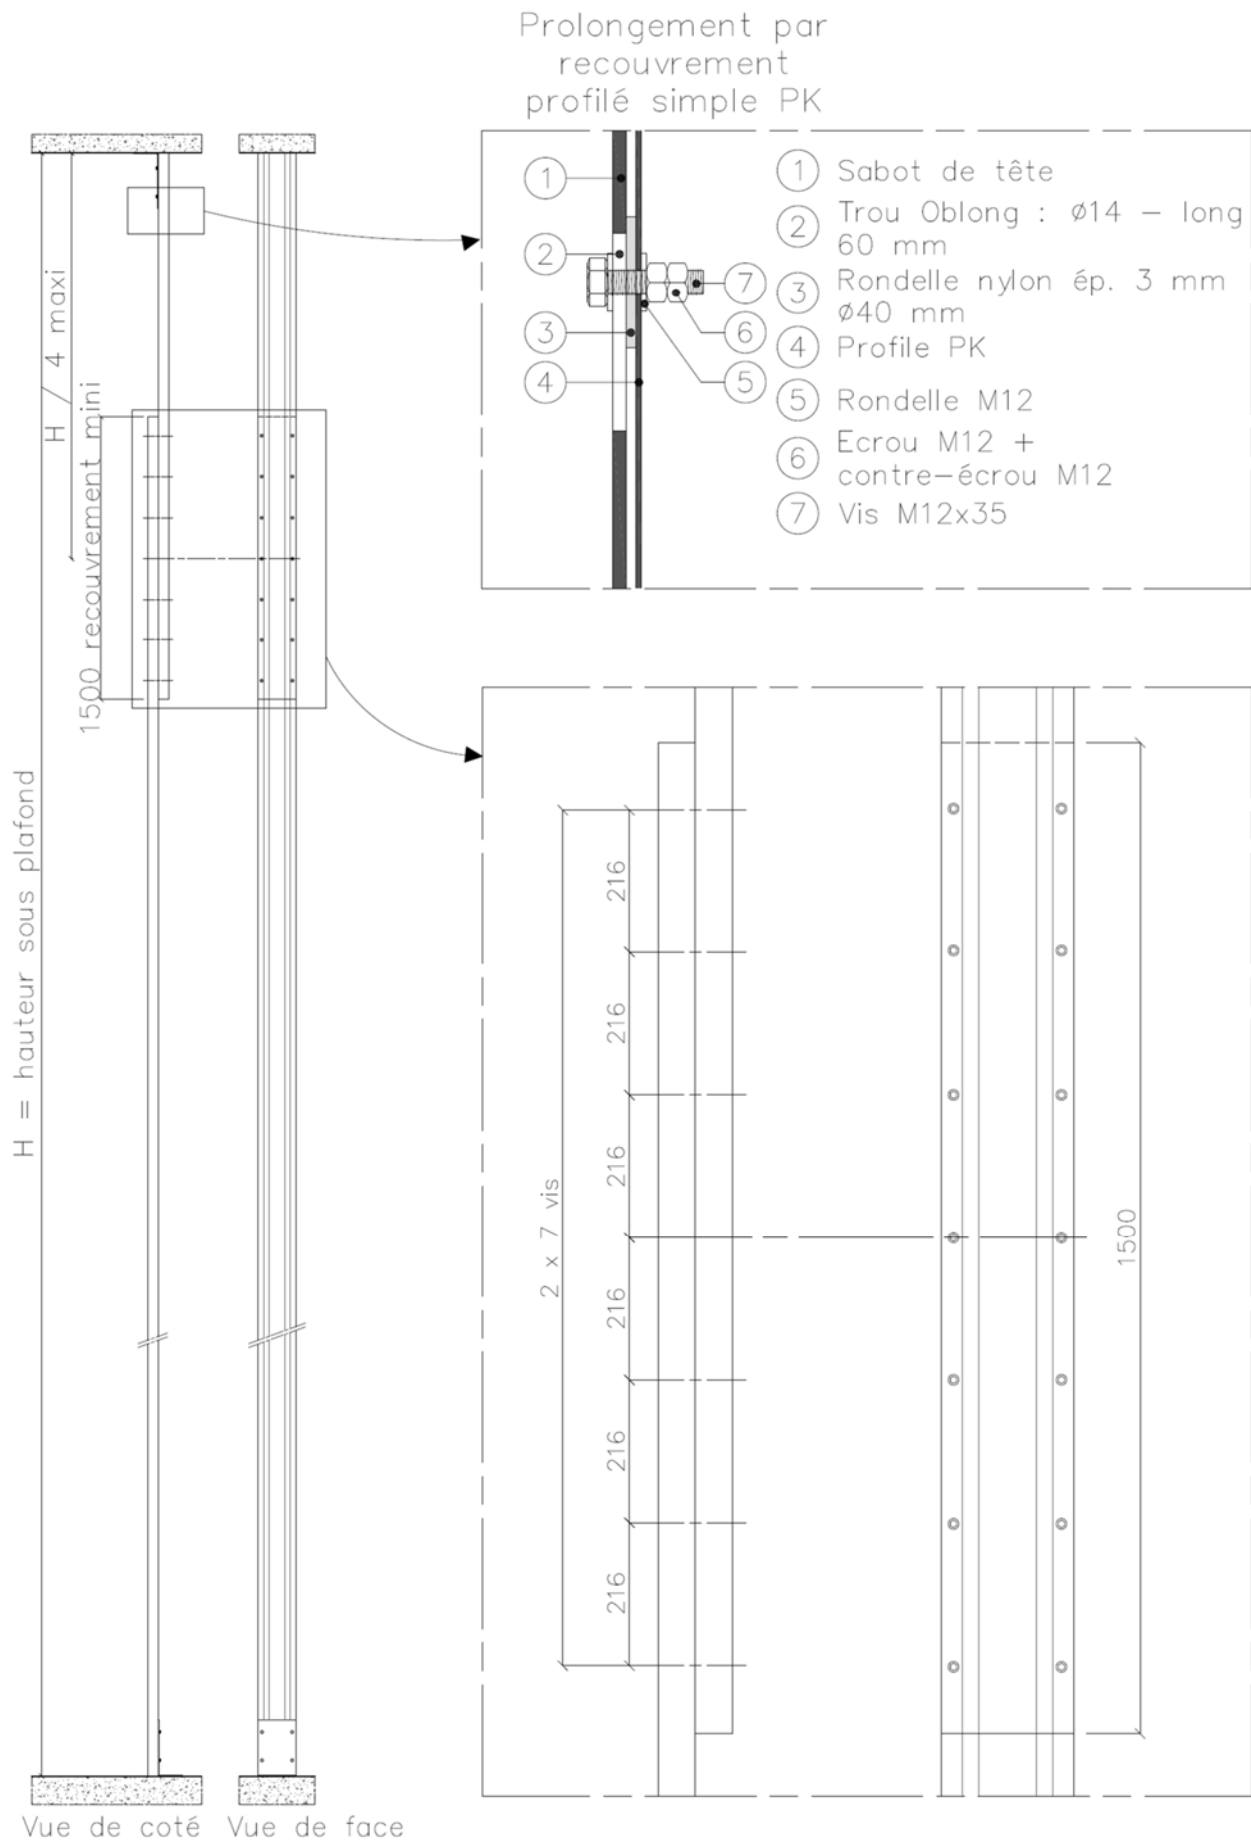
Prolongement par recouvrement d'un profilé primaire GH Futur – Vue en élévation
